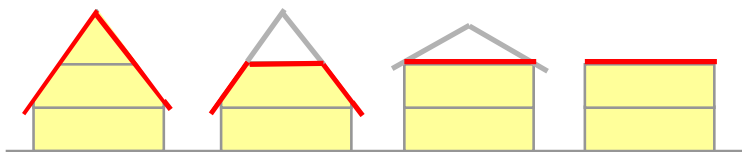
Wärme übertragende Dachbauteile
